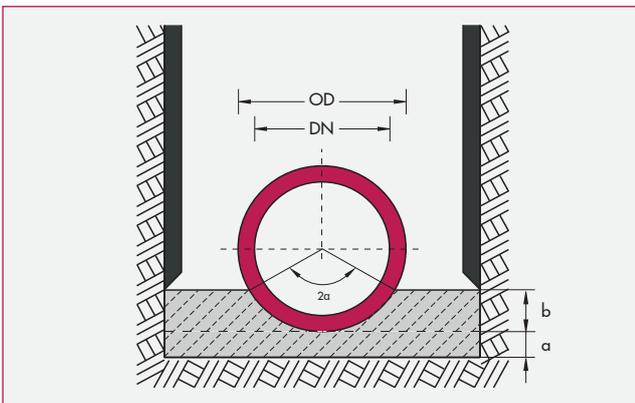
Empfohlene Ausführung für Betonbettung nach DWA-A 139 für Rohre ohne Fuß $a = 50\text{mm} + 1/10\text{ DN}$, min $a = 100\text{mm}$ (obere Bettung, nach Rohrverlegung betoniert)
